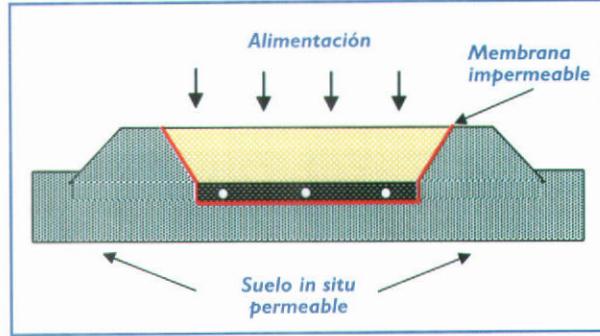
Sistema drenado con un macizo drenante estanco gracias a una membrana impermeable (Agencias del Agua, 1993)
